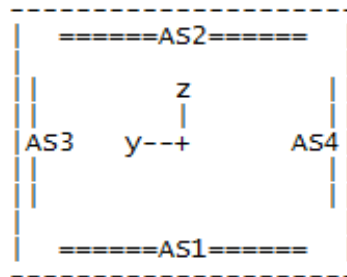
Схема армирования №3, в форме креста, уголка
